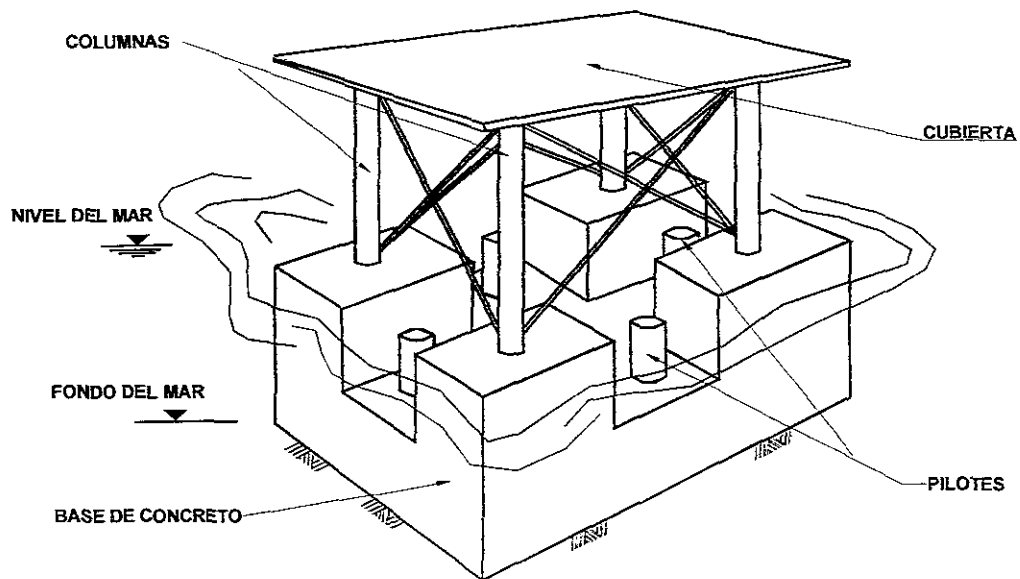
Estructuras con Armazón de Concreto de Tipo Flotante con Cimentación.^(1,2)
